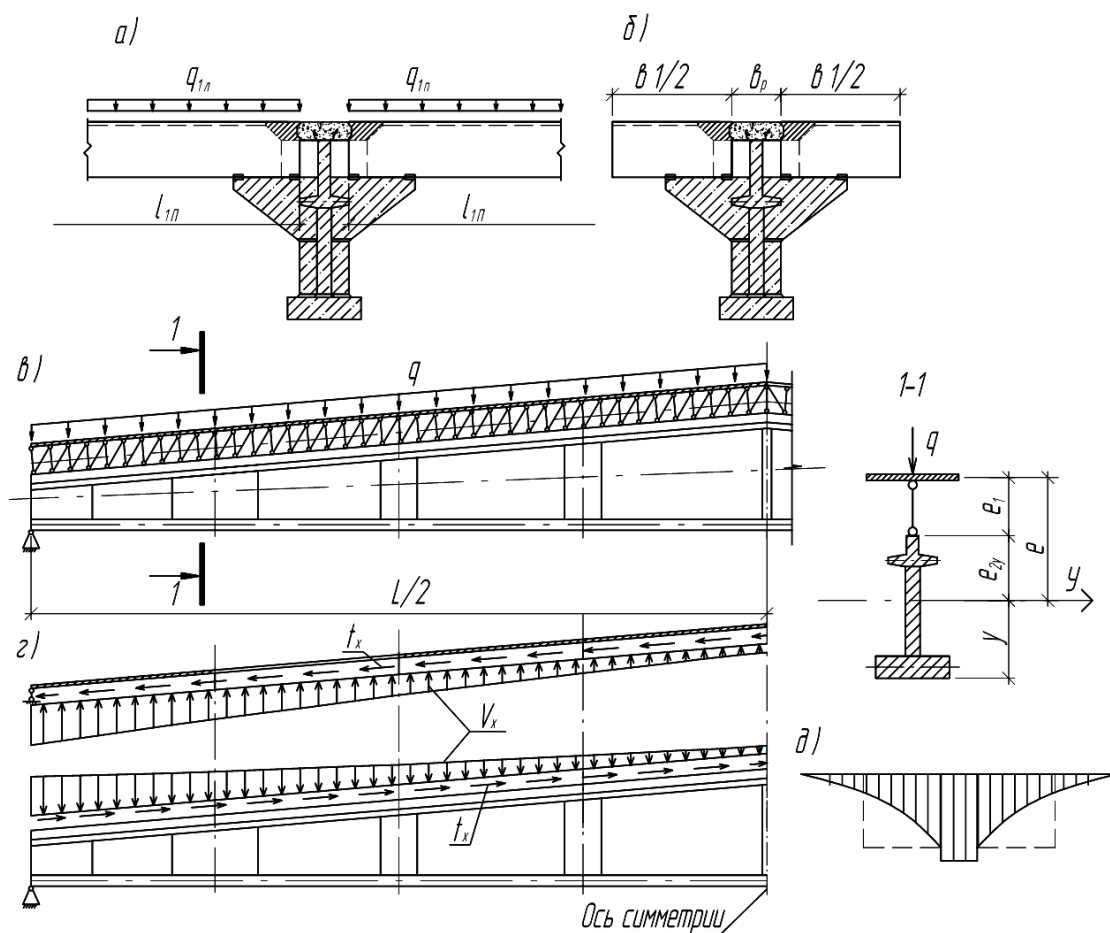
Расчетная модель сборно-монолитной стропильной конструкции с плитами покрытия: а) пространственная составная конструкция; б) плоская составная конструкция; в) континуальная расчетная модель в виде двухпоясной составной балки с без моментным верхним поясом; г) основная система метода сил; д) эпюра нормальных напряжений в плите и ригеле
